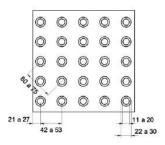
Sinalização tátil de alerta - Modulação do piso
